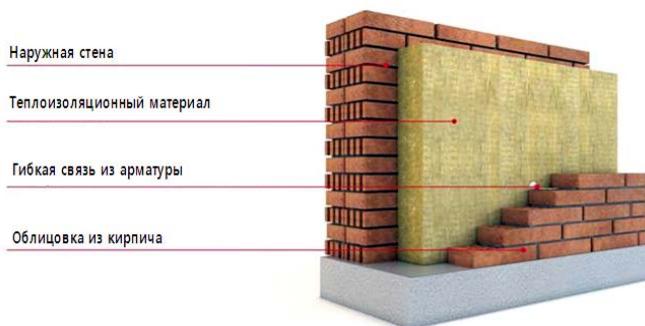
Конструкция наружной стены с облицовкой кирпичом
